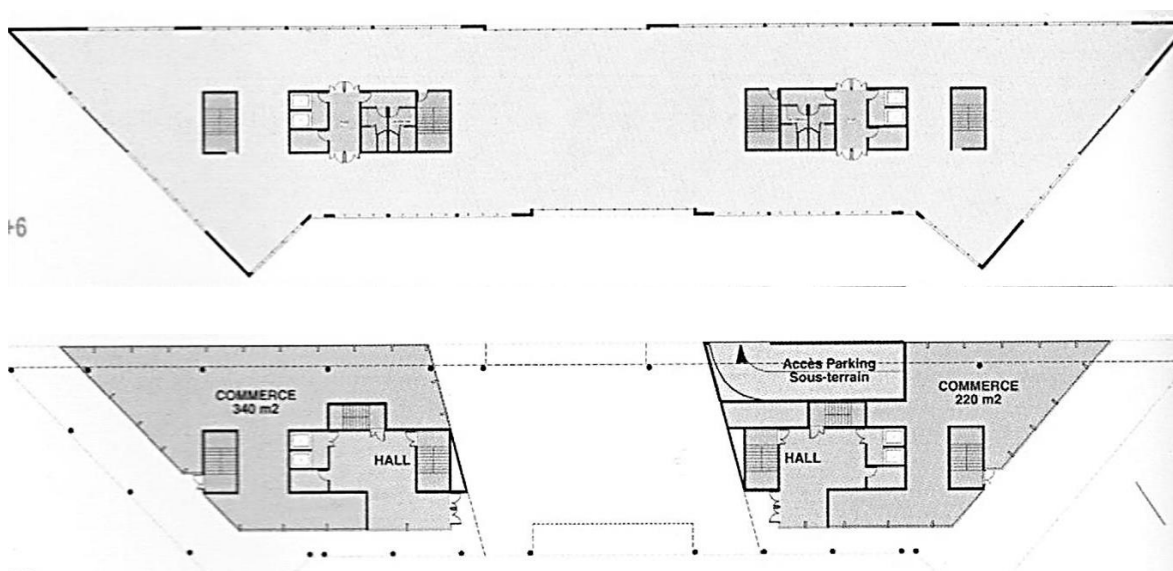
Plans des niveaux RDC et R+6 d'un immeuble de bureaux, à Montpellier, Architecte Bedeau, 2003.
